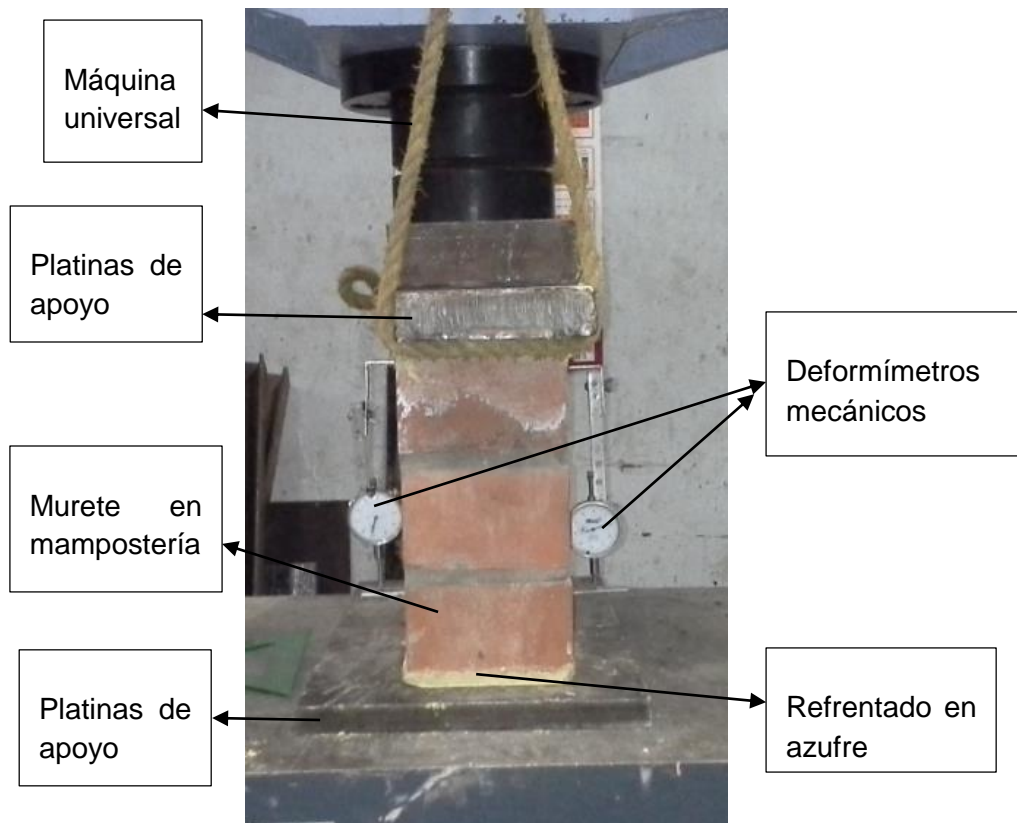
Montaje del ensayo a muretes de mampostería. Fuente: el autor
